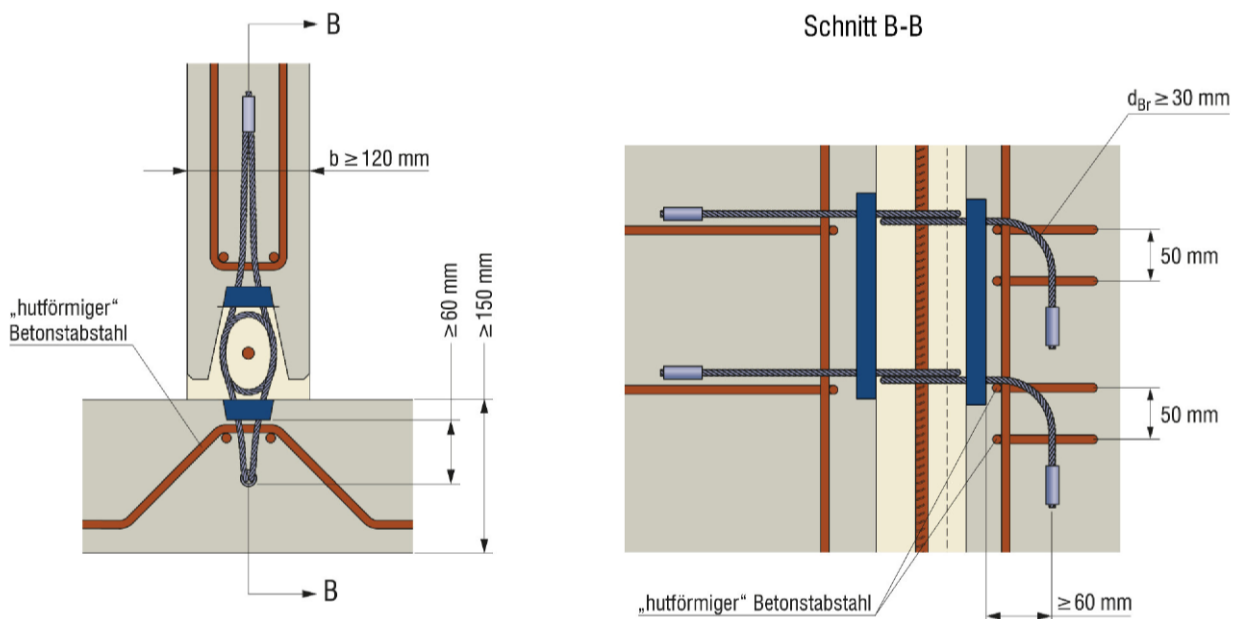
Wand – Wand – T-Verbindung - Detail mit abgewinkelten Seilschlaufen
